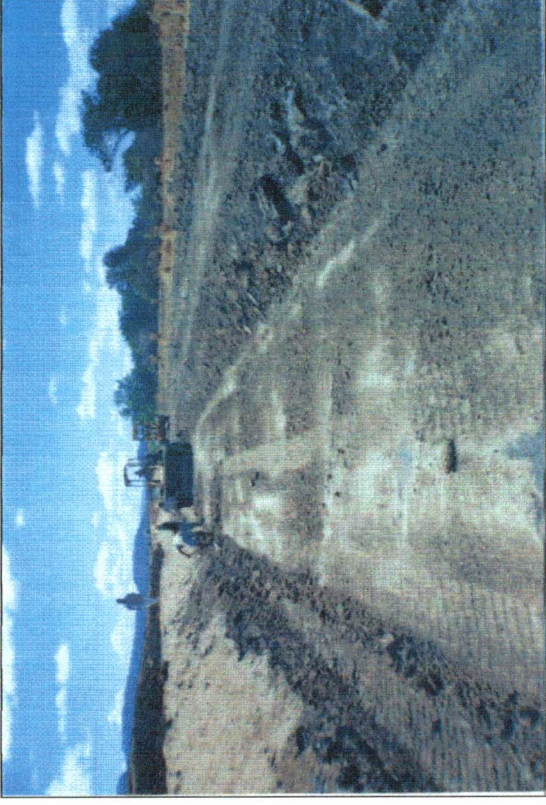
Escavação para o rock-fill entre est. 28 à 32.
